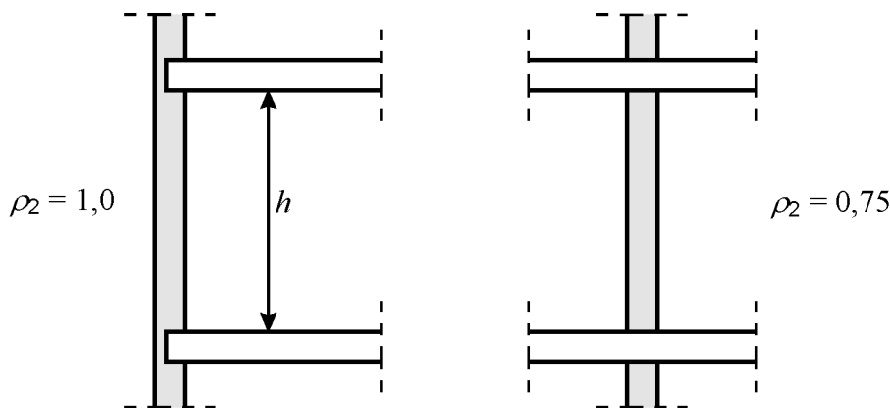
Coacción al giro debida a los forjados o a la cubierta
